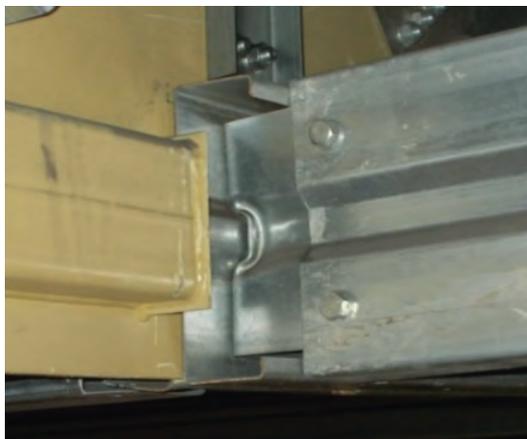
Крепление распорки к нижнему поясу фермы в первом от опоры узле
